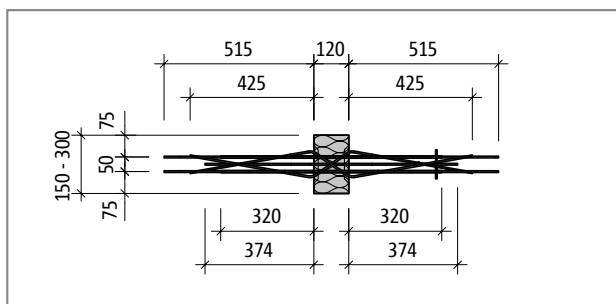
Schöck Isokorb® tipo WXT1: pianta del prodotto
